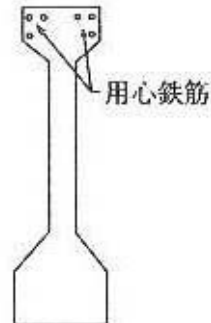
フランジ幅の小さいけたの用心鉄筋の例
